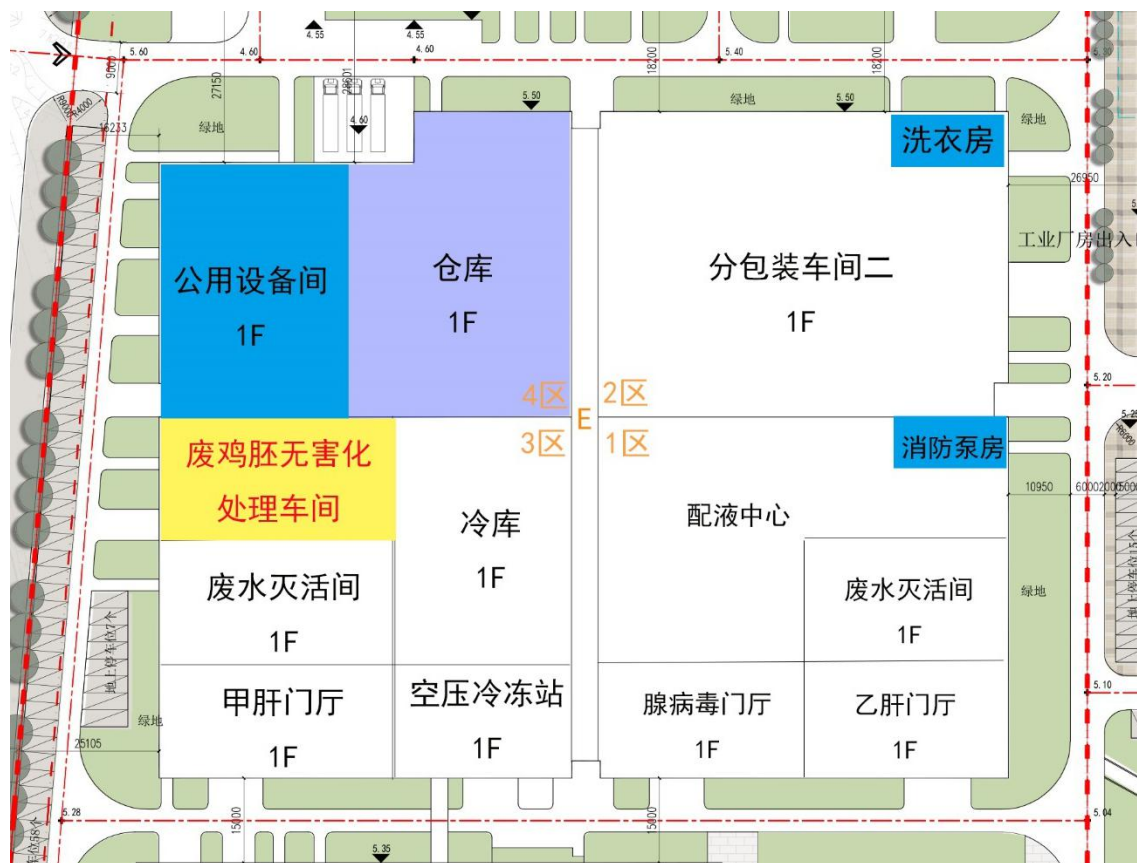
基地废气排气筒、废水排放口设施平面布置图
